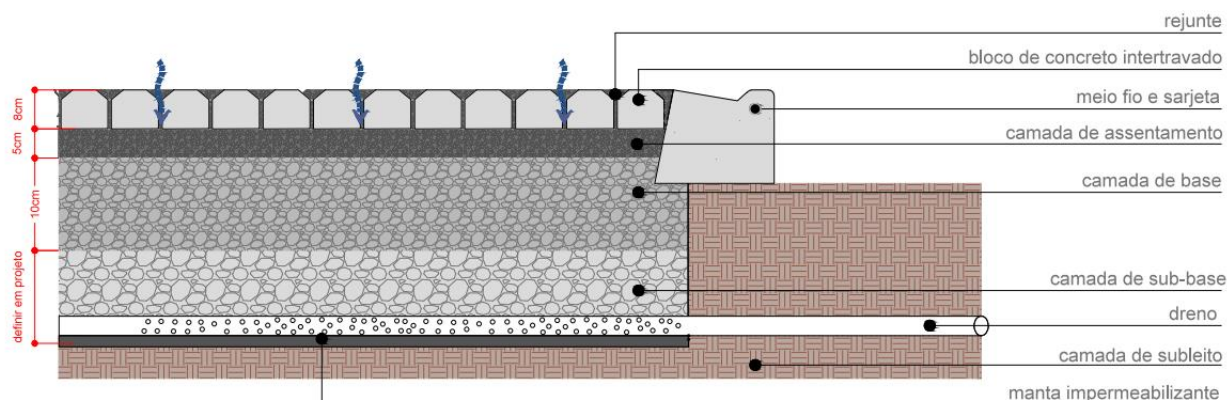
Pavimento intertravado permeável com infiltração total no solo
